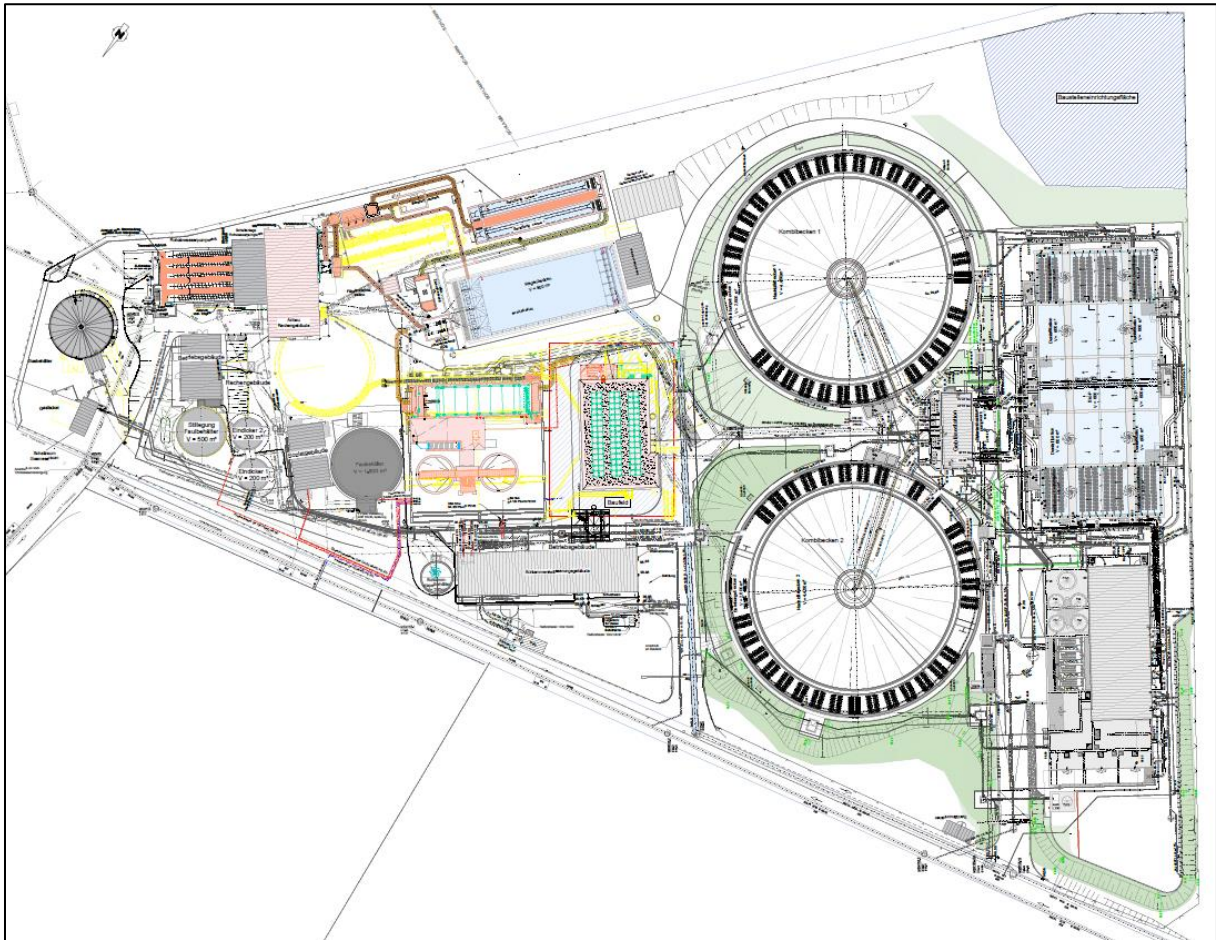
Stand Umplanung April 2024 zur Auftragsvergabe Bauabschnitt 3
